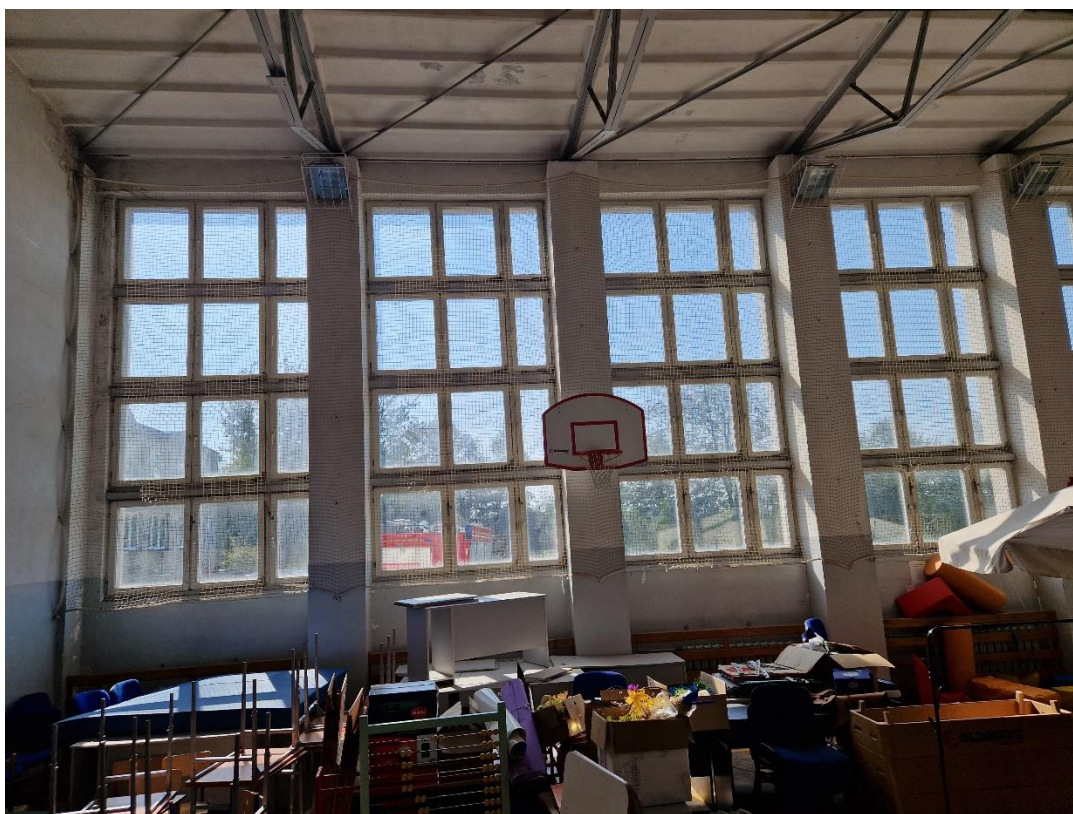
Widok zarysowań elewacji zachodniej sali gimnastycznej.
